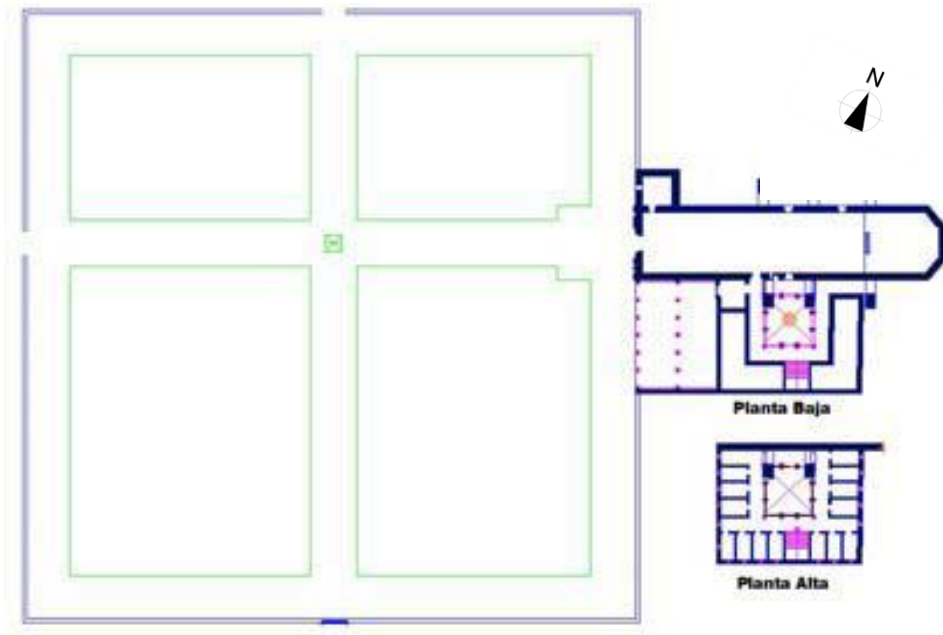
Reconstrucción de la planta arquitectónica del monasterio de Tiripetío.1541.³⁶
